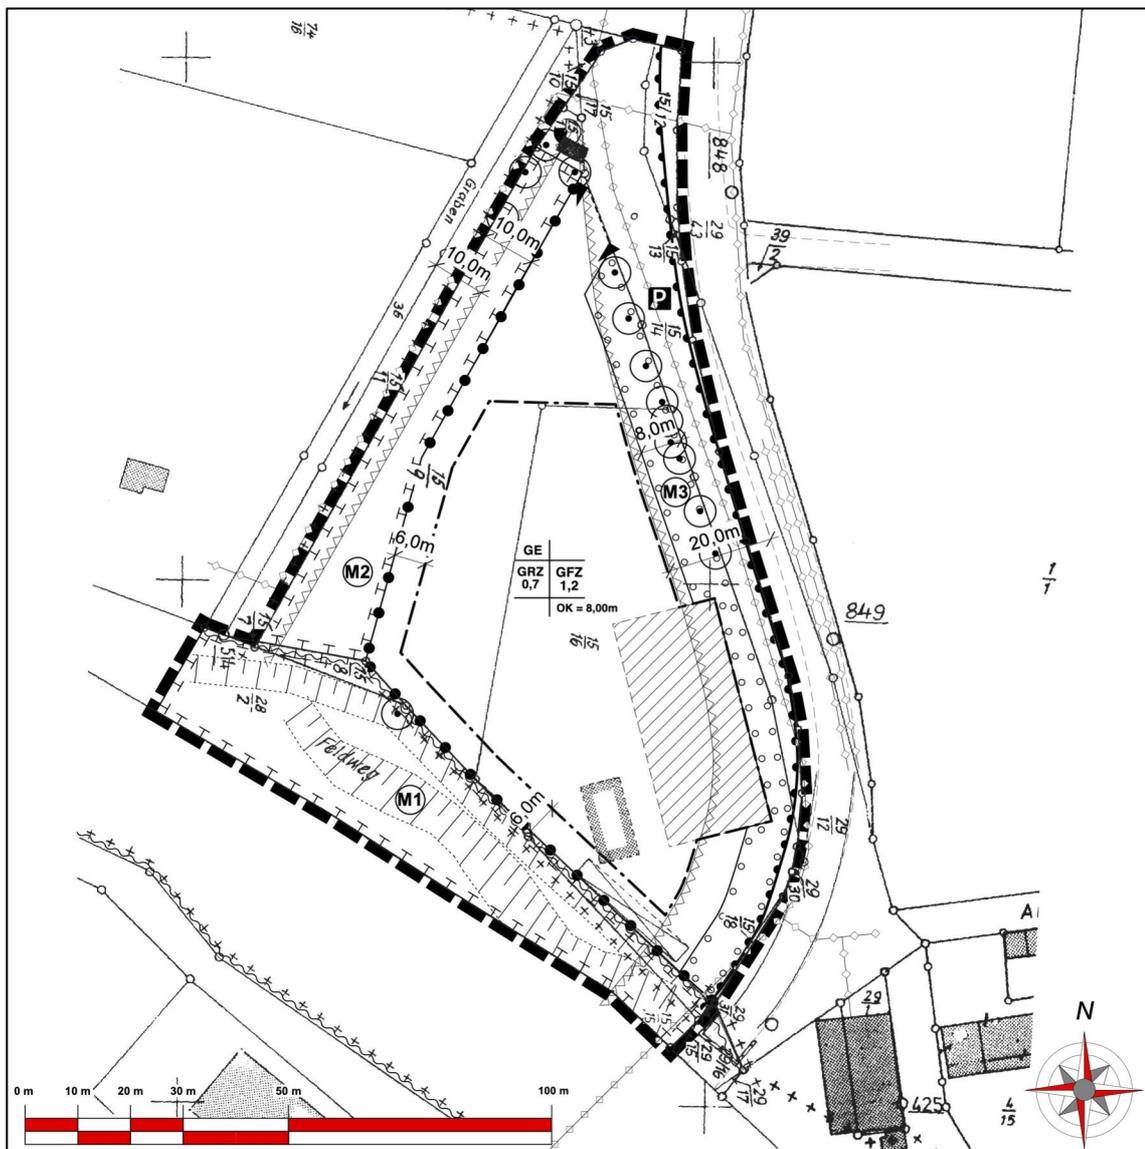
Planungsrechtlicher Bestand - Ausschnitt Alt-Bebauungsplan
